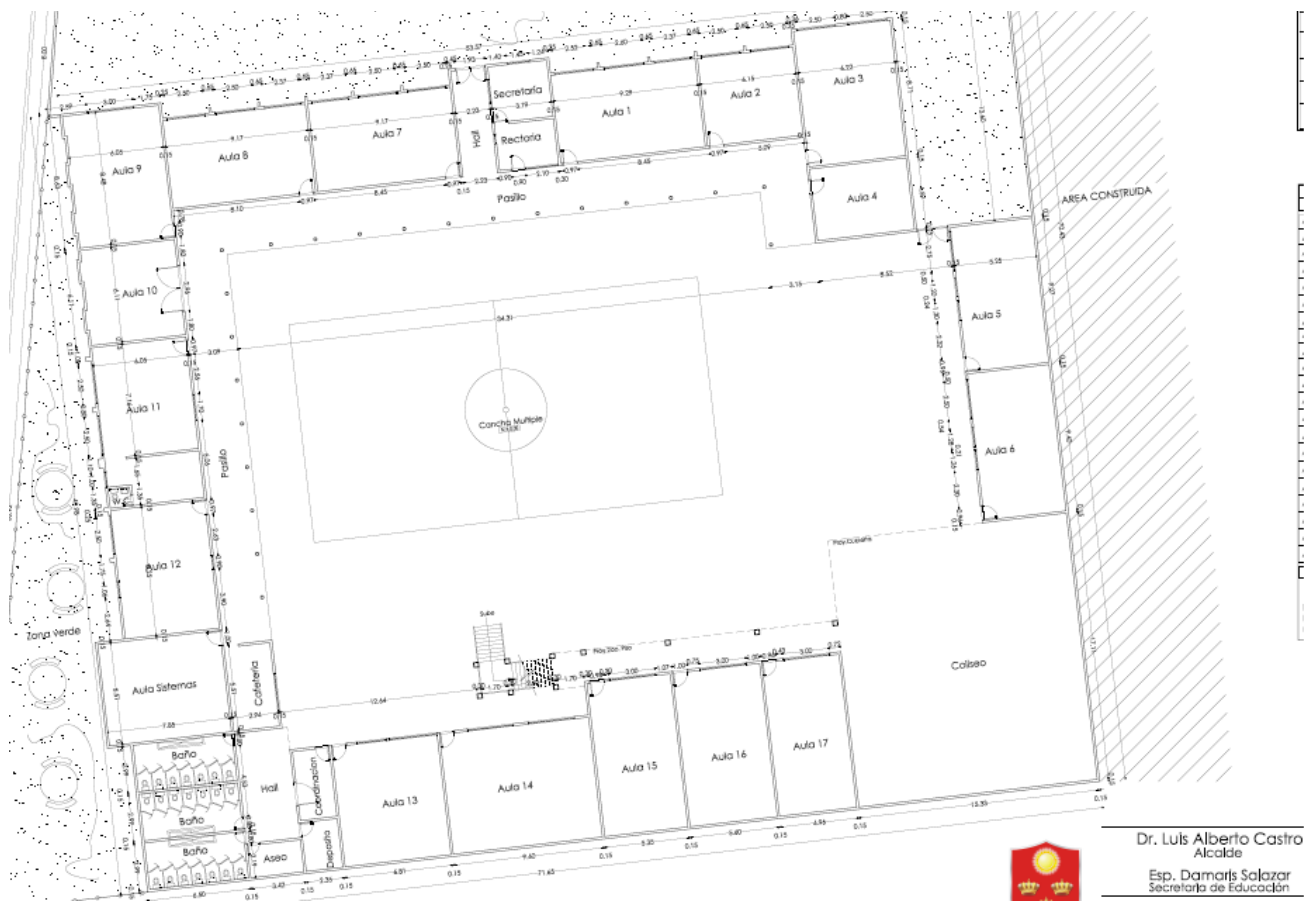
Plano arquitectónico. Planta 1° piso, 2005.
